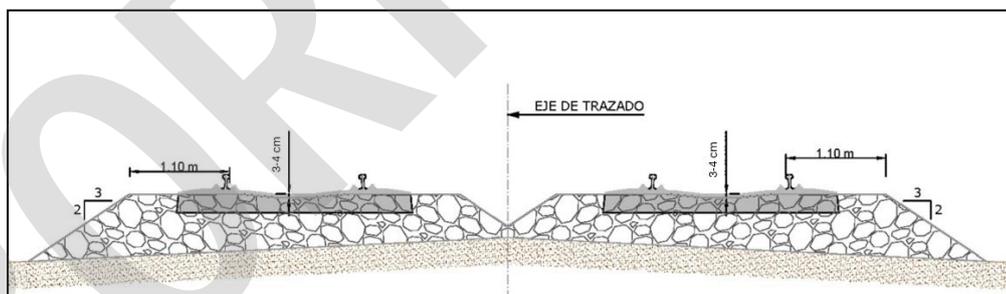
Esquema de perfilado de balasto en la caja de la vía.
